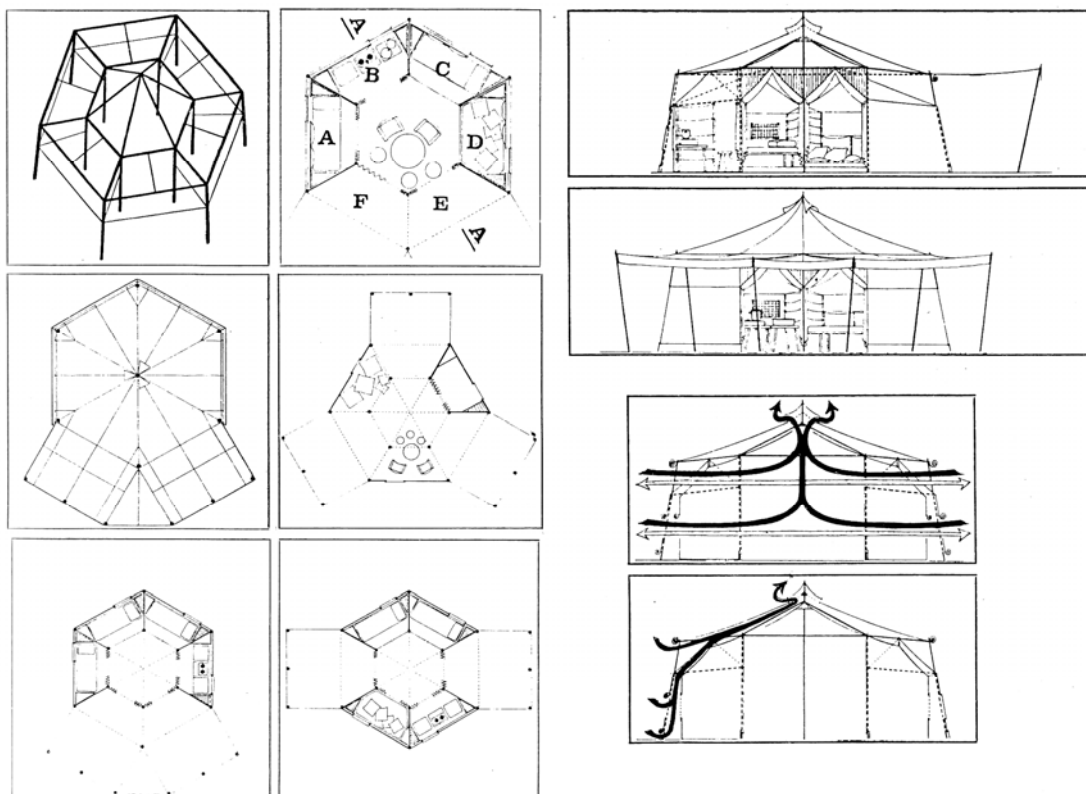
La casa-tenda di R.Manghi –schemi planimetrici e strutturali
